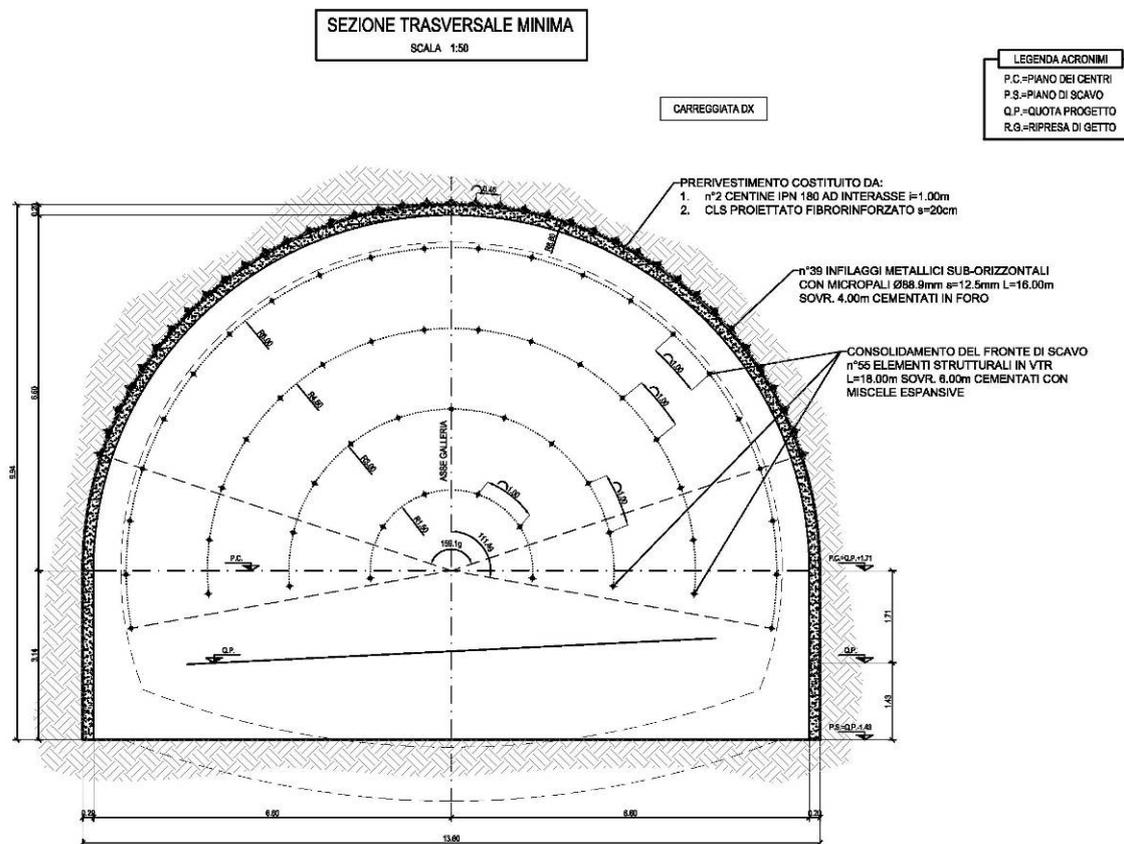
Sezione trasversale (minima) della sezione tipo B2v.
